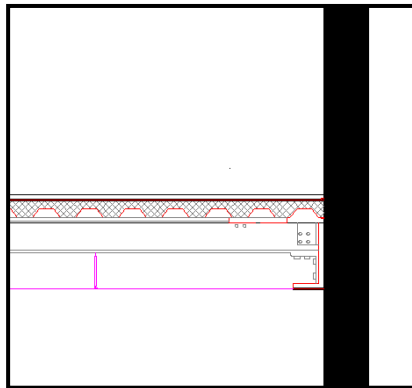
coupe illustrant le détail d'articulation entre plancher collaborant et mur / Source : Auteurs
